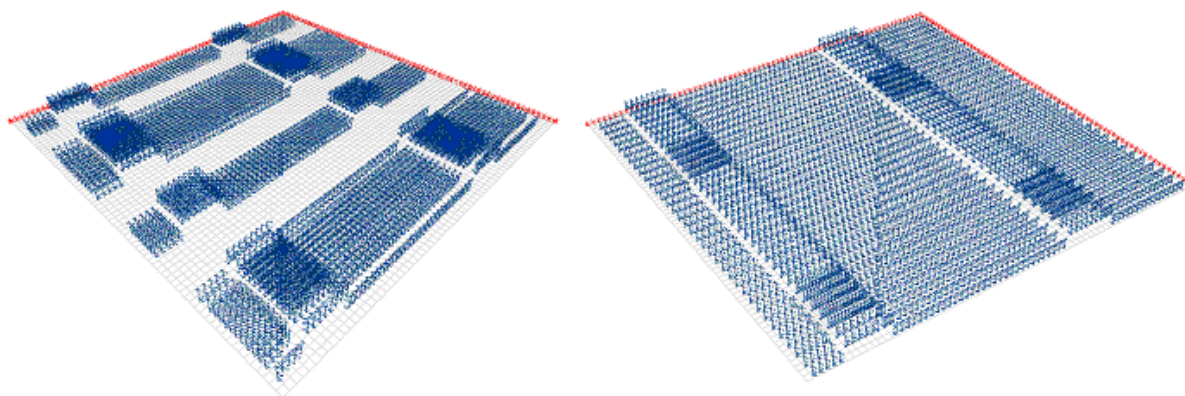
Exemplo dos carregamentos equivalentes de protensão aplicados ao pavimento
